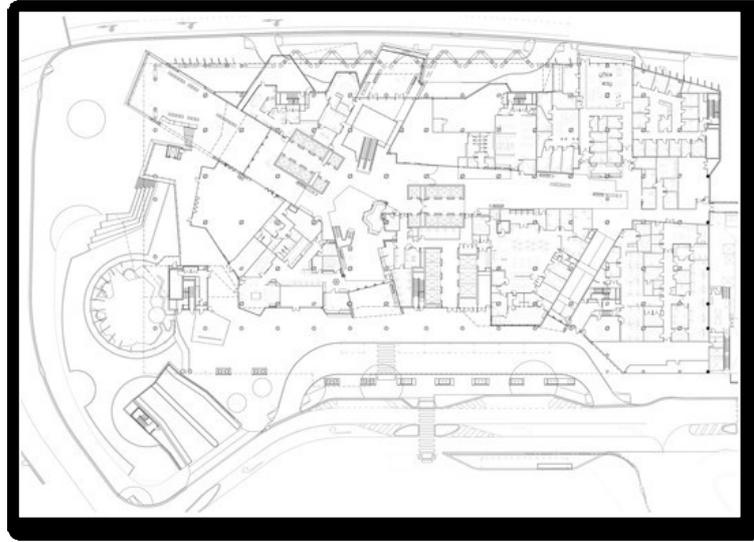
Plan d'assemblage de l'hôpital new lady.⁵³
